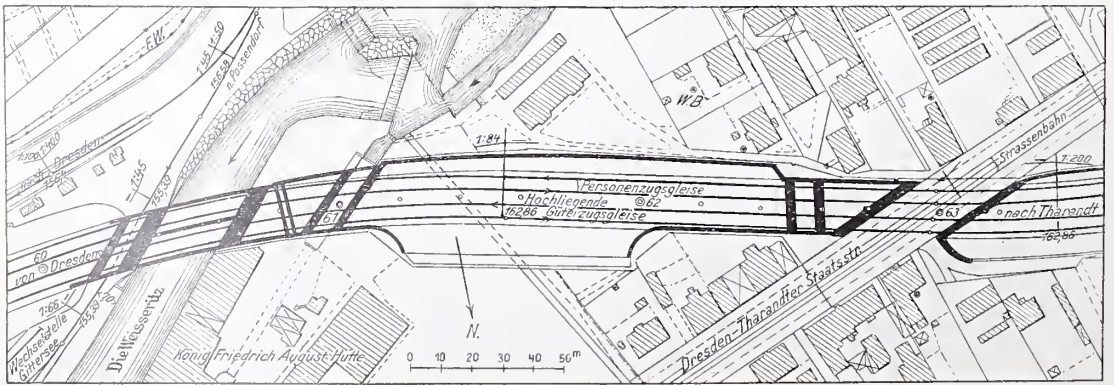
Lageplan nach vollendetem viergleisigem Ausbau.
